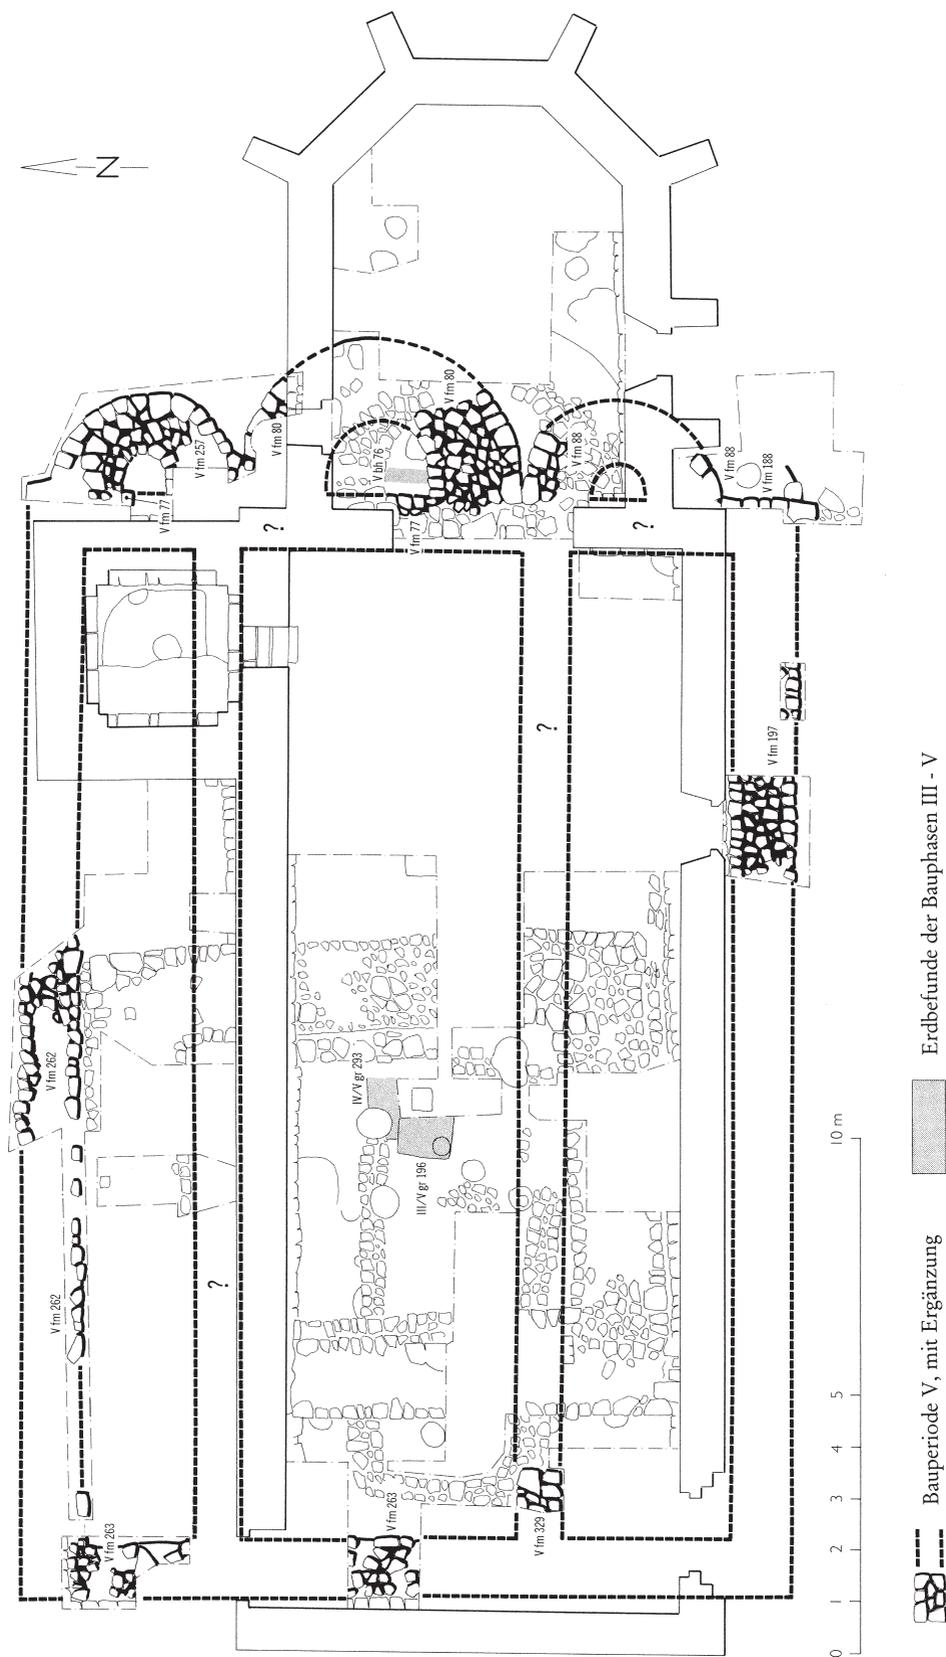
Starzach-Wachendorf, Kirche SS Peter & Paul. Grundrissplan Bauphase V (Zeichnung: Th. Schwarz, LDA Baden-Württemberg).
